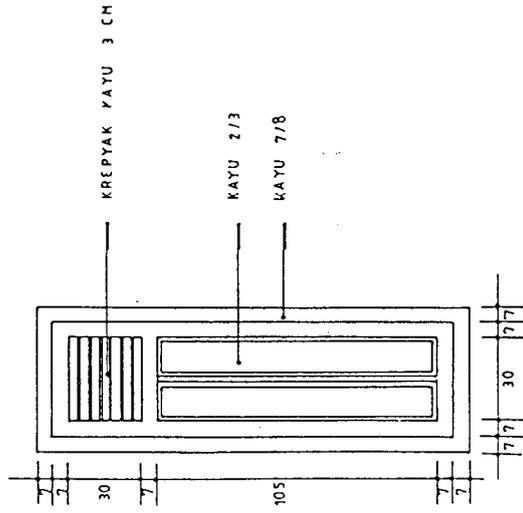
DETAIL JENDELA PADA OMAH DHUWUR GALLERY
